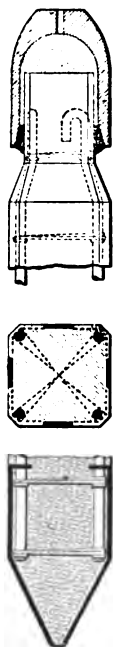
Eisenbetonpfahl mit Schlaghaube n. System Hennebique.
